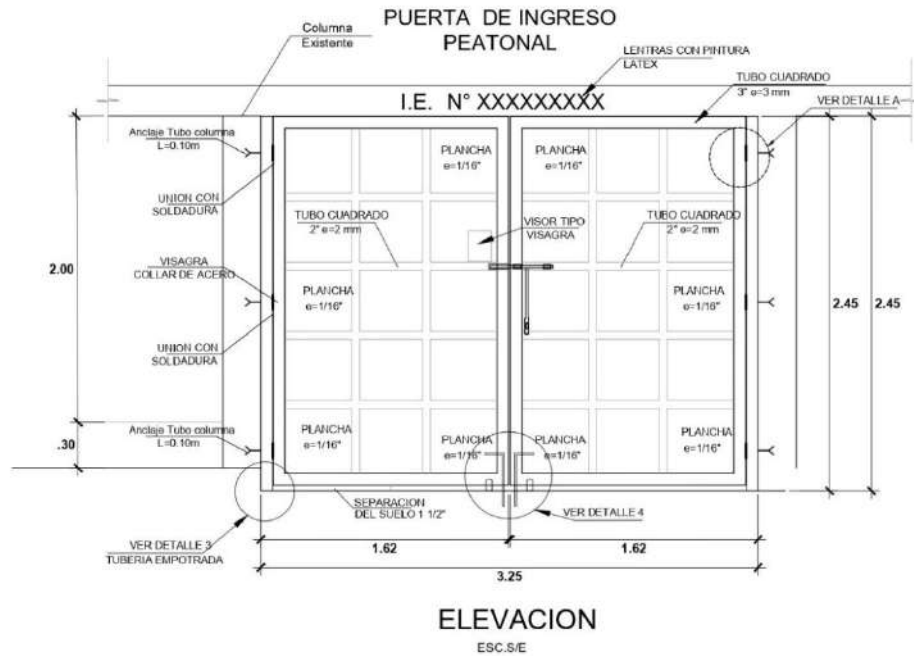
IMAGEN REFERENCIAL PARA LA PROPUESTA DE PUERTA DE ACCESO METÁLICA (incl. piso y losa de concreto)
